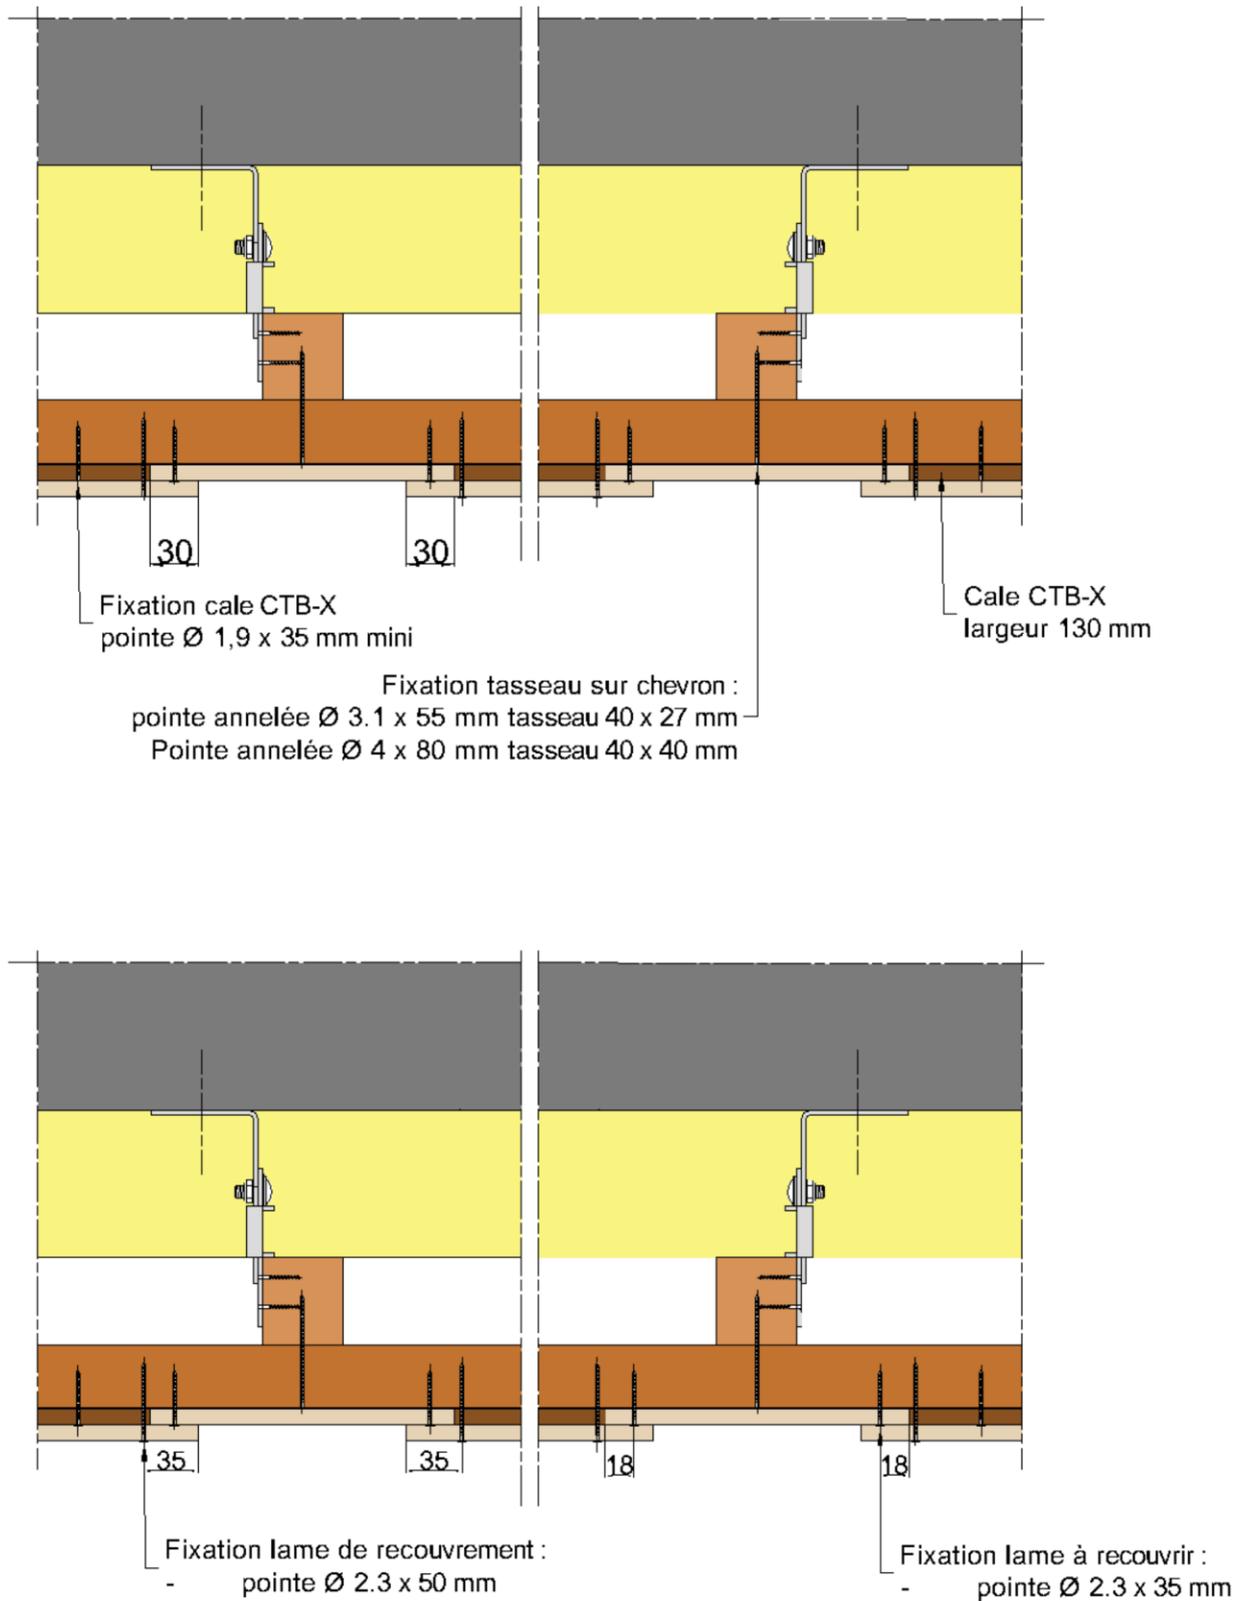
Fixation de la lame CEDRAL LAP pose verticale
